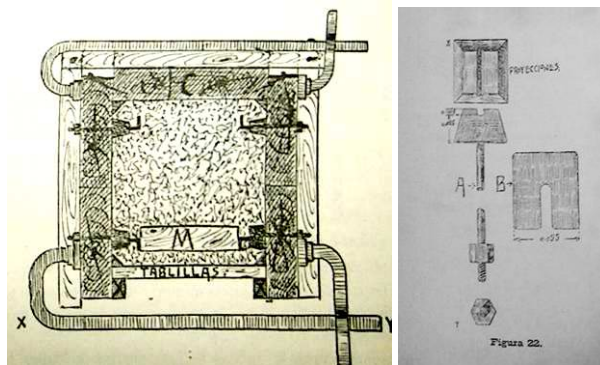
Encofrado de pilar. (Jalvo, 1903).
